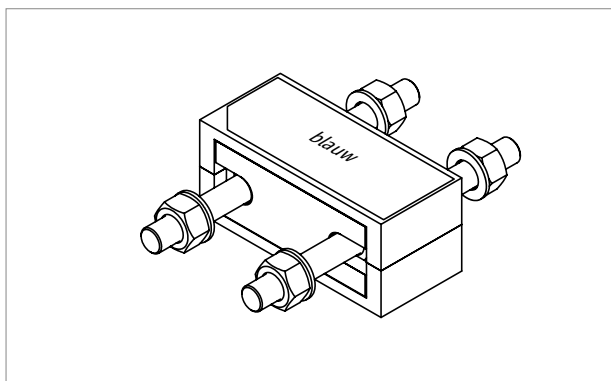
Schöck Isokorb® T type S-V-D16: Vooraanzicht
